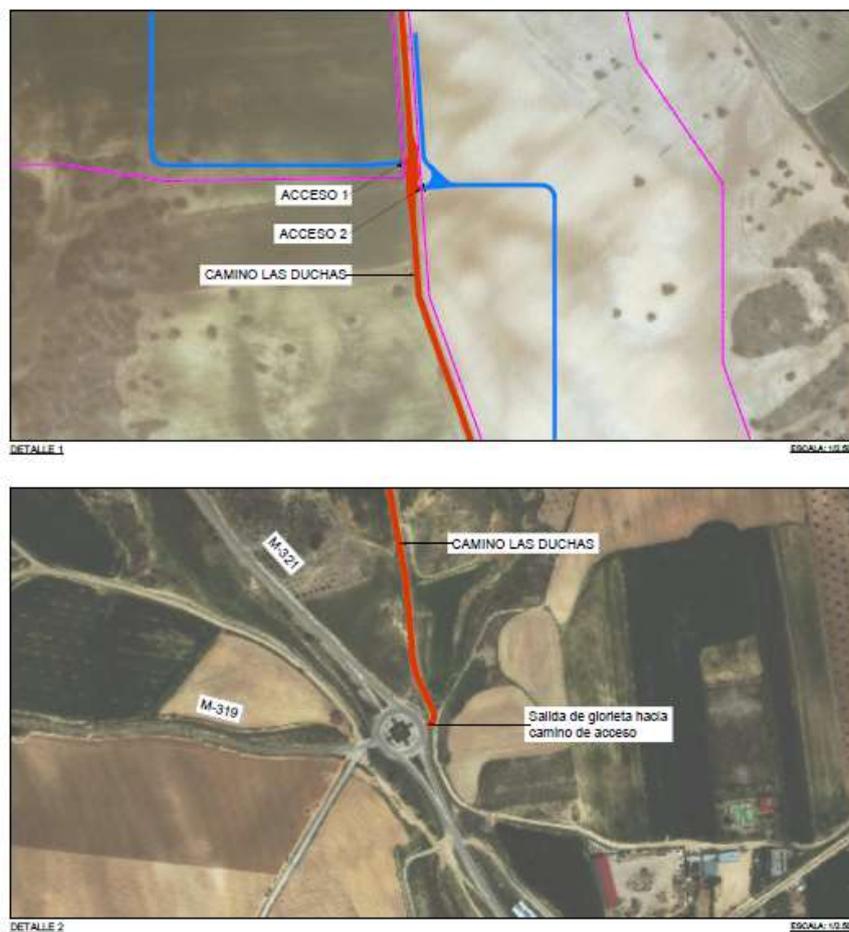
Detalles del camino de acceso a la planta fotovoltaica
